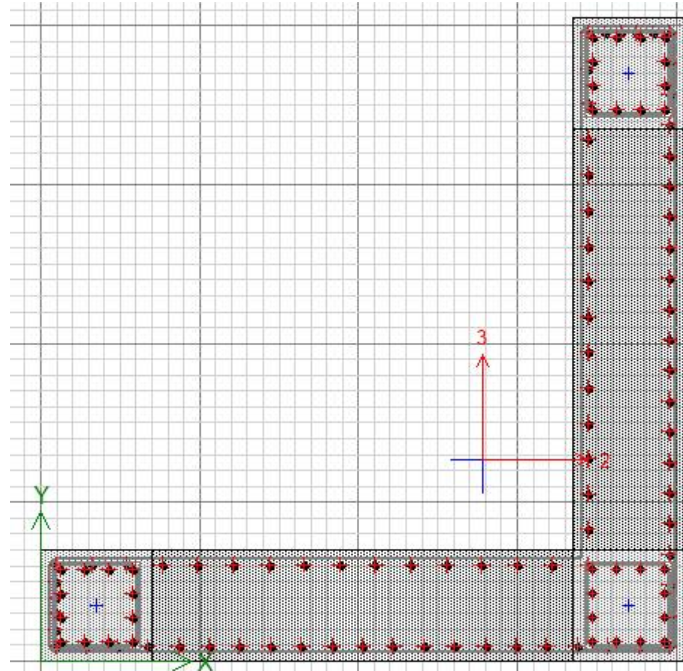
Diseño de muro sección pier con elementos de borde.
